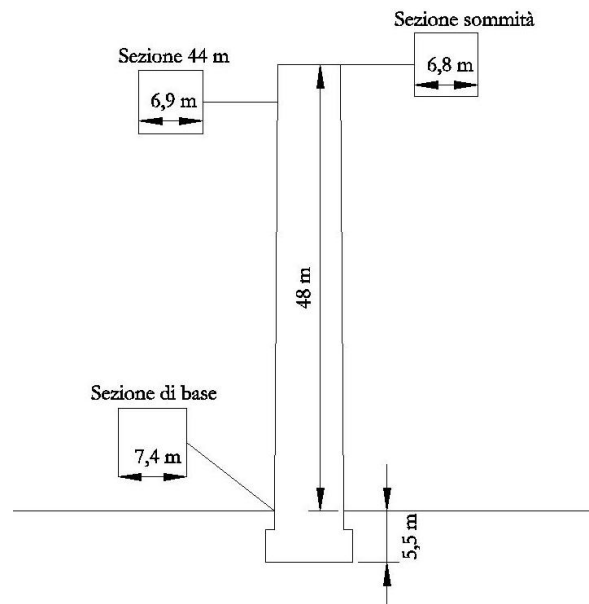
Ricostruzione schematica della sezione della Torre Garisenda (Traversa, 2011).
